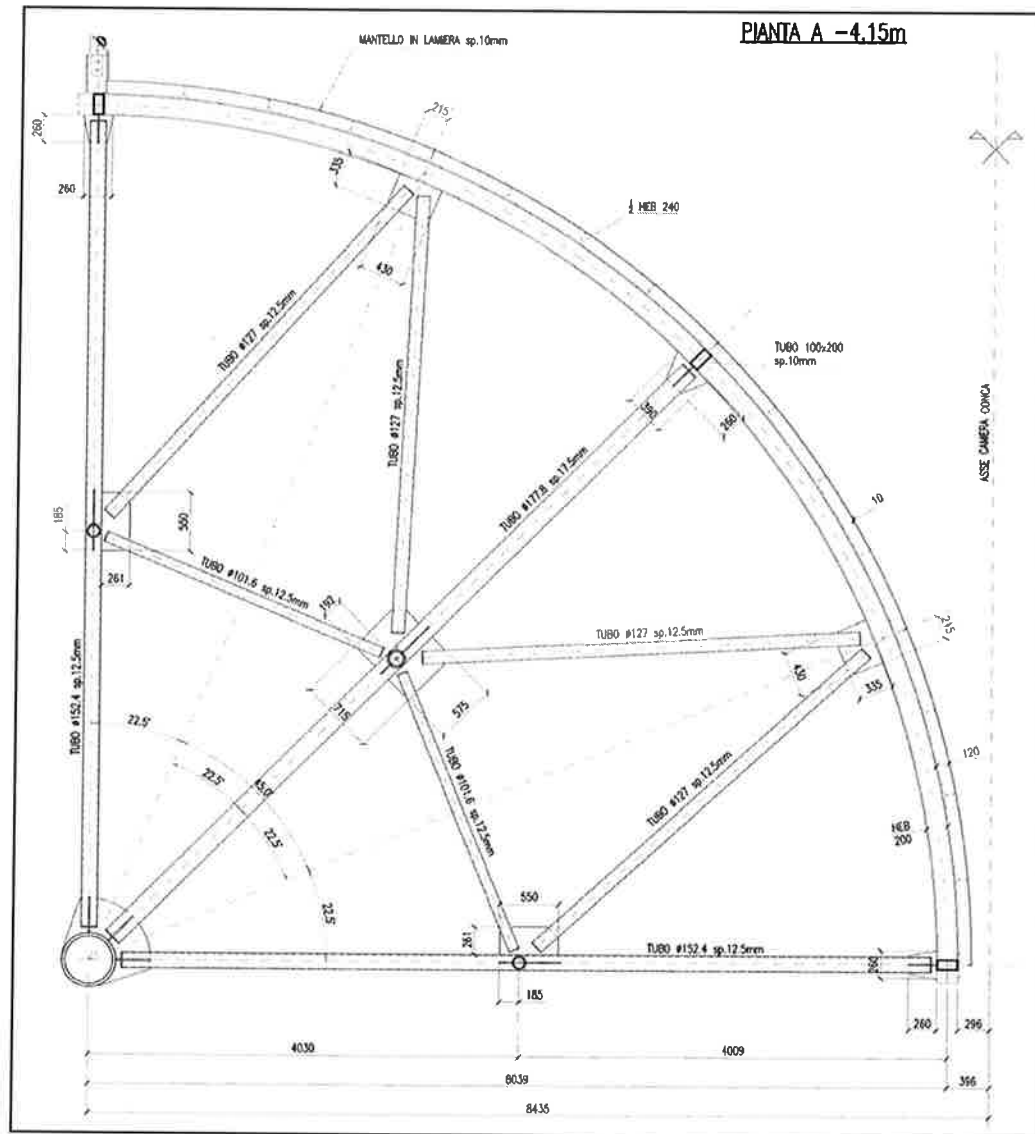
PIANTA TRALICCIO SPAZIALE PORTE CONCHE DI CHIOGGIA
